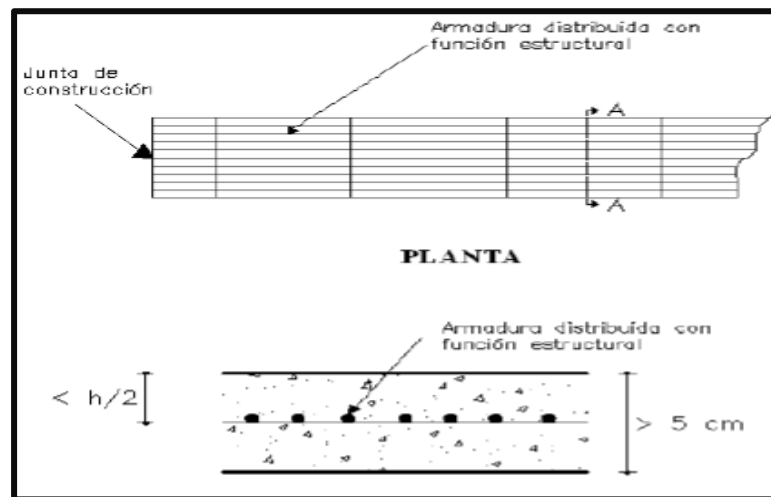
; Pavimento de Concreto Armado con Refuerzo Continuo
